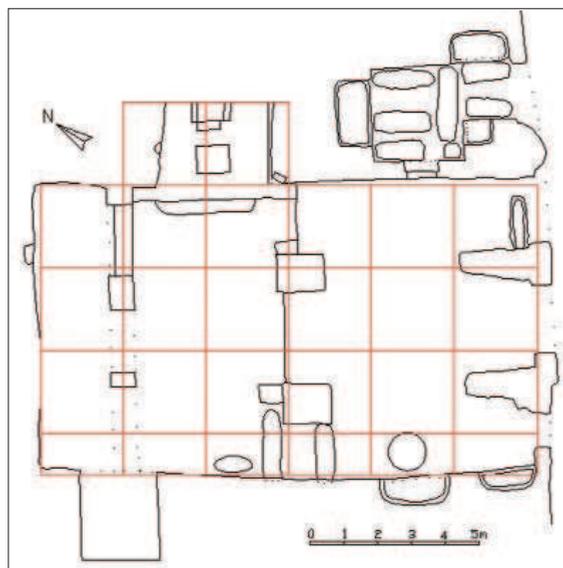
Buscemi, Basilica rupestre di S. Pietro. Pianta: lettura progettuale
